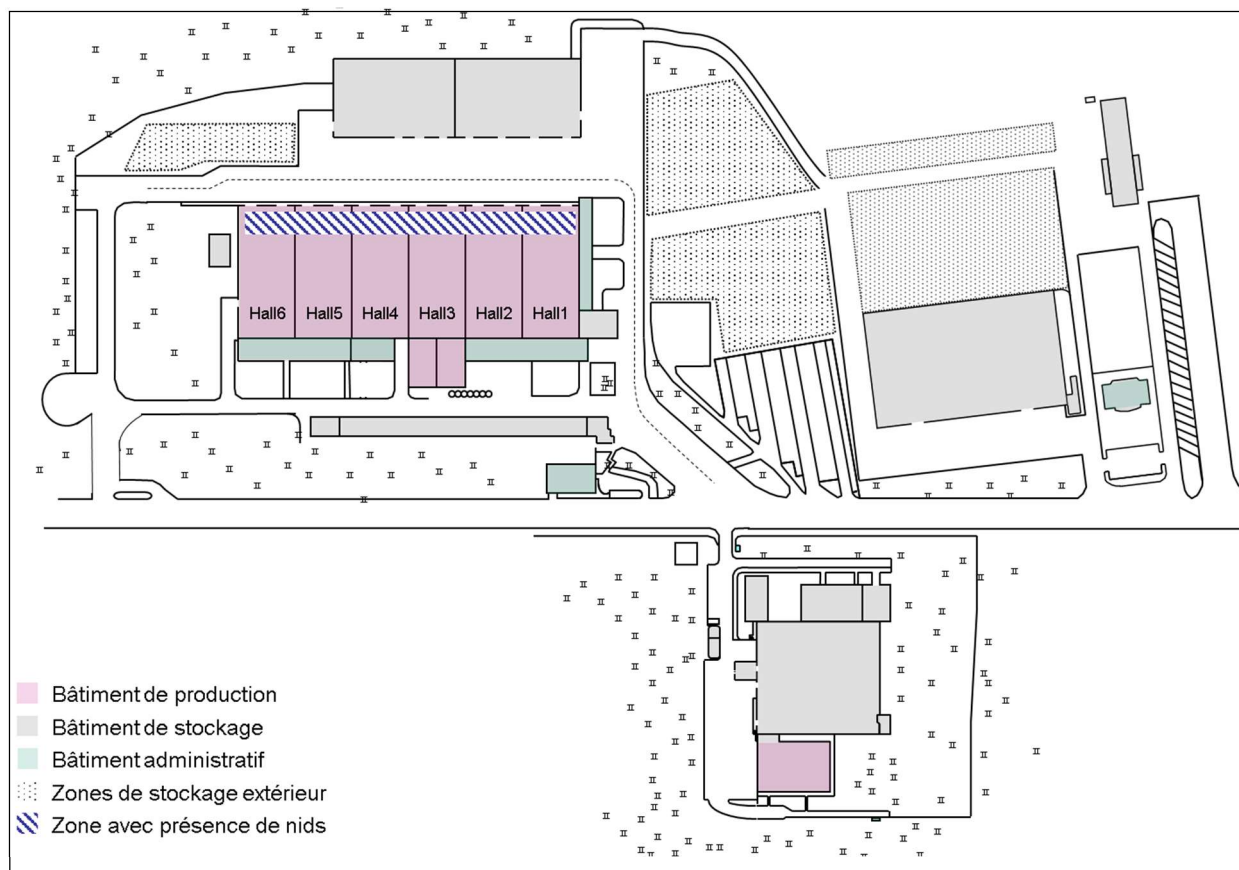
Plan de masse du site – Localisation de la zone de nidification
